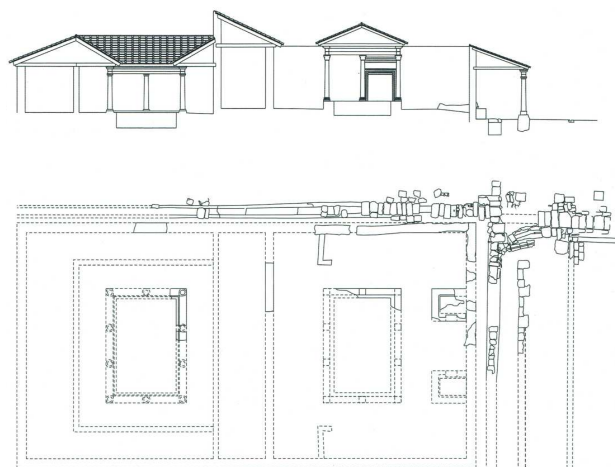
Planta y sección del Santuario. Año I-II d.C.
